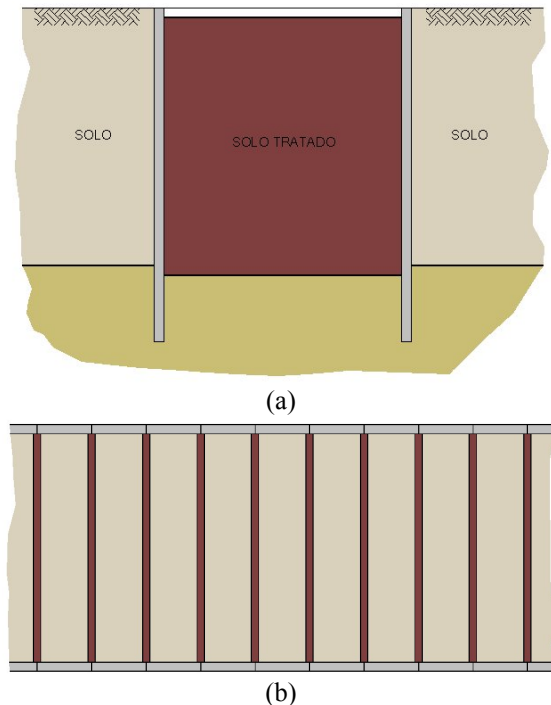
Travamento transversal até ao topo das paredes periféricas com painéis CSM: a) corte transversal à escavação; b) planta
